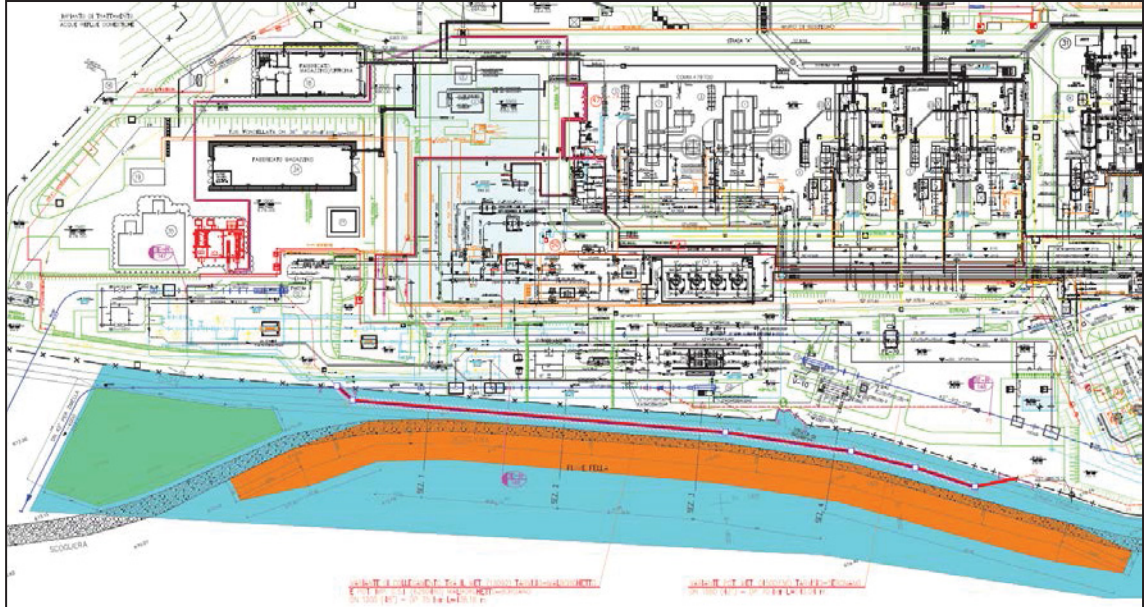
Stralcio della Planimetria di progetto con occupazione delle aree temporanee di lavoro.
